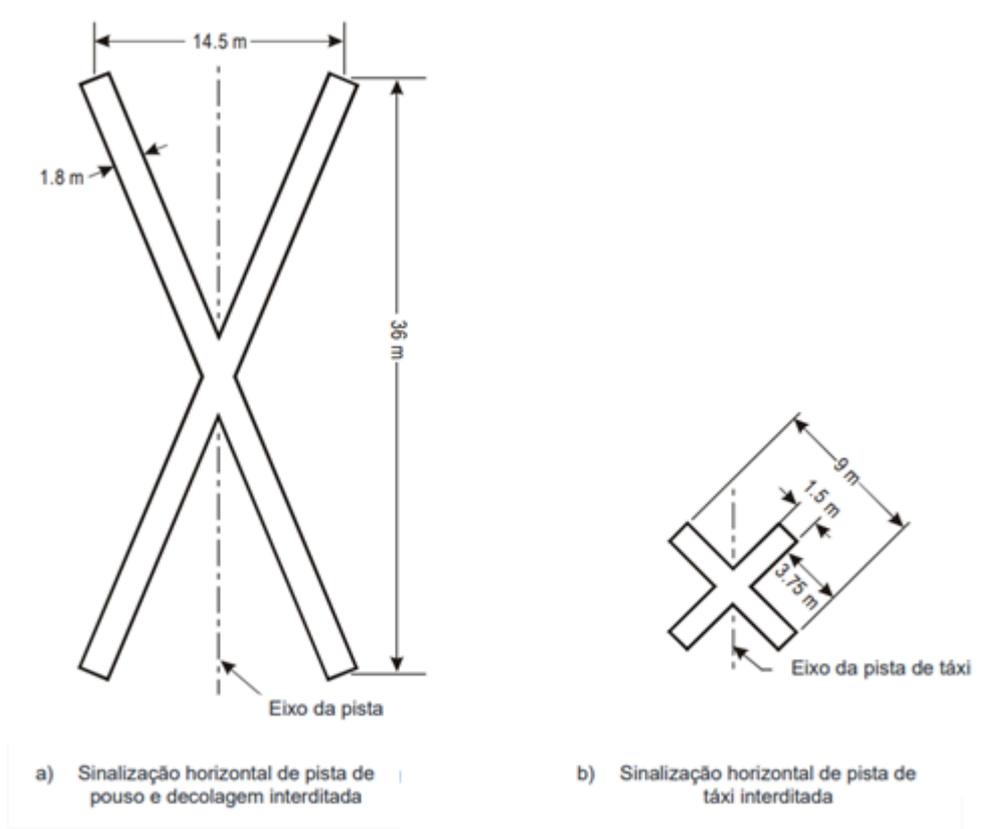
Sinalizações horizontais de pistas de pouso e decolagem e de pista de táxi interditas
